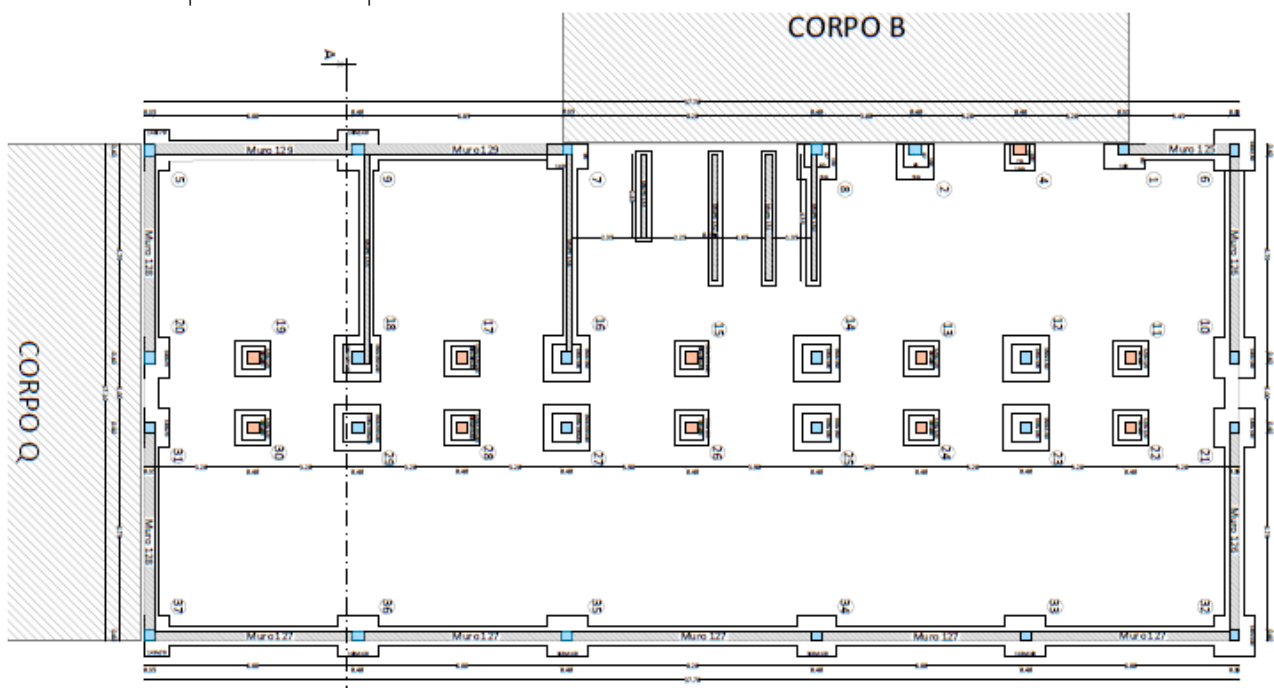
Blocco A-Planimetria Struttura di Fondazione esistente.
